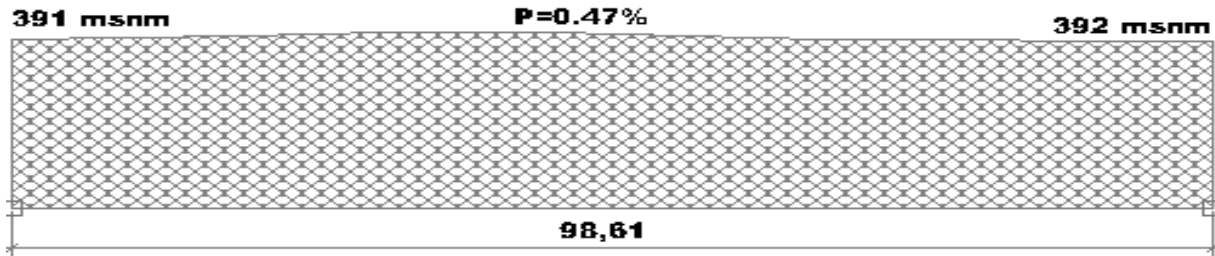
CORTE LONGITUDINAL A' – A'' Fuente: SAS PLANET
